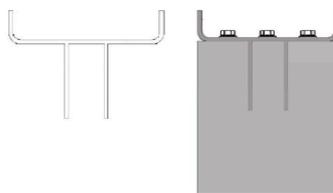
Reforço de viga através da colocação de duas chapas verticais soldadas a perfil UNP (González-Bravo, 2011)
